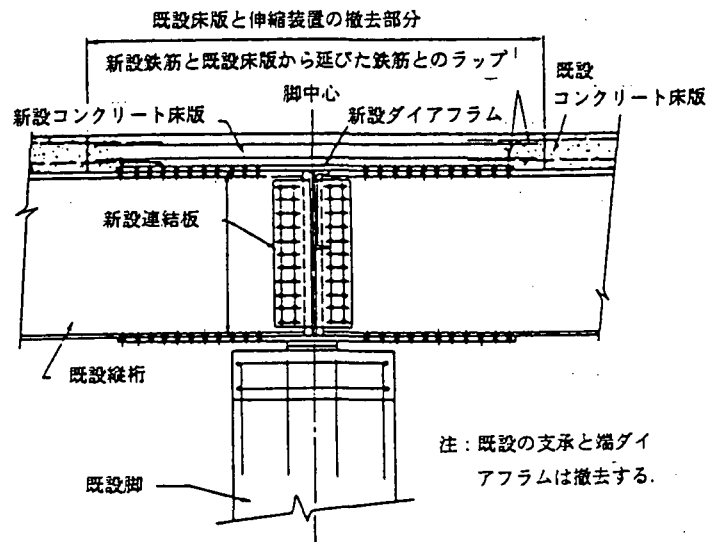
モーメントとせん断タイプ継手の概念上の詳細
